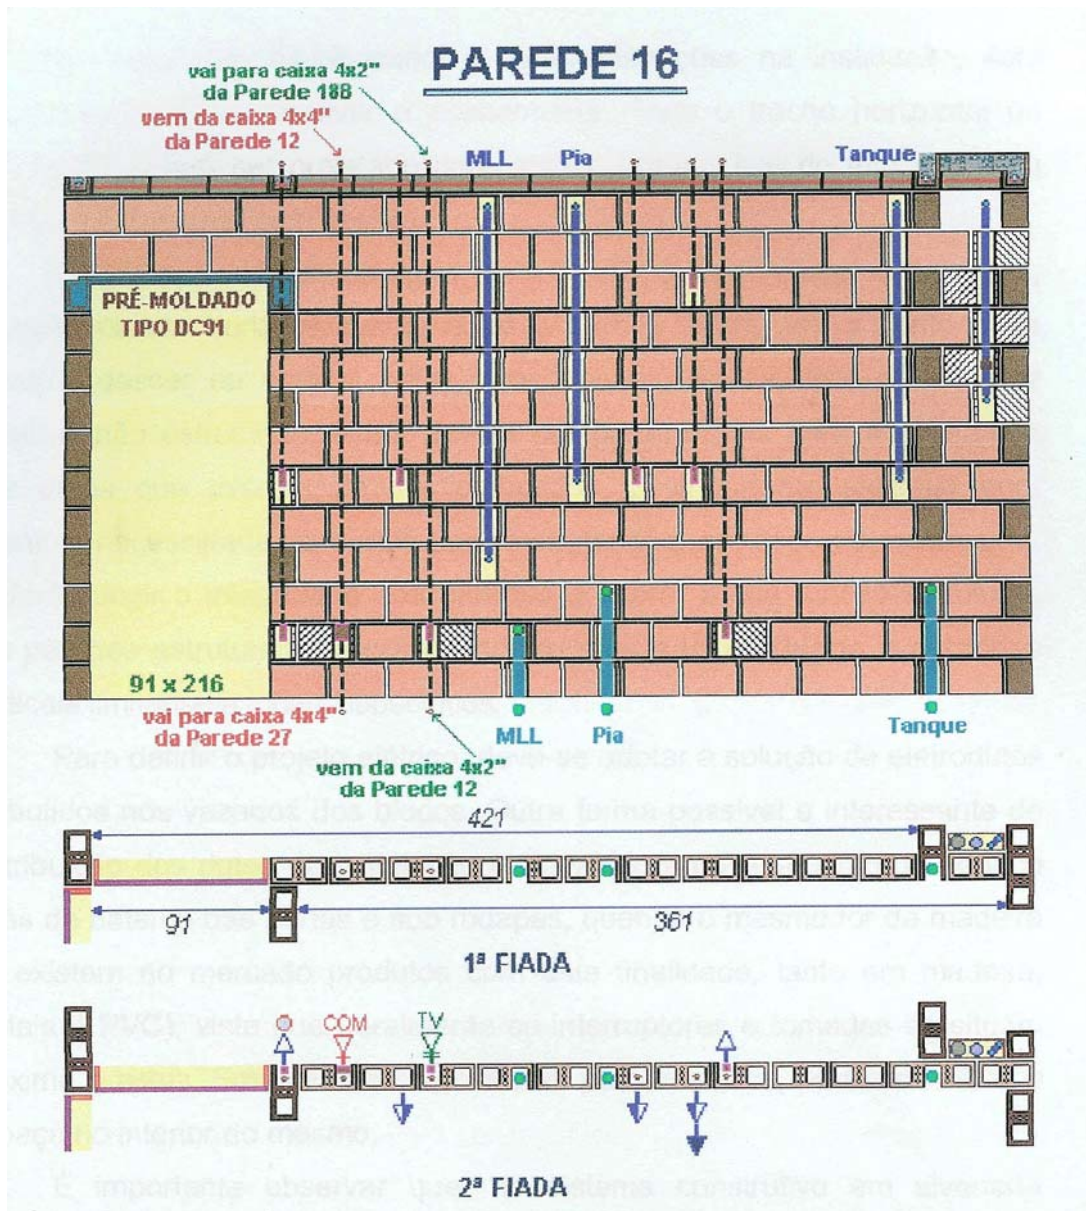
Exemplo de elevação (POZZOBON, 2003).
